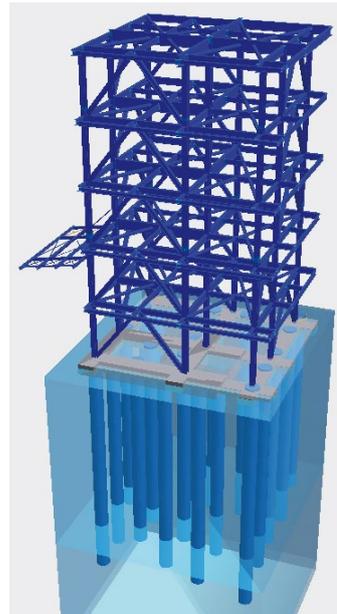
Gründung eines Gerüsts mit Bodenplatte, Pfählen und Zerrbalken
